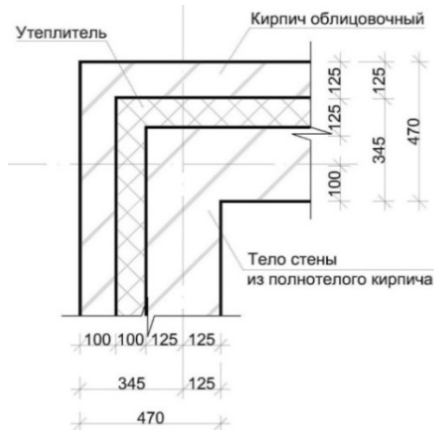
Разрез наружной несущей стены толщиной 470 мм
